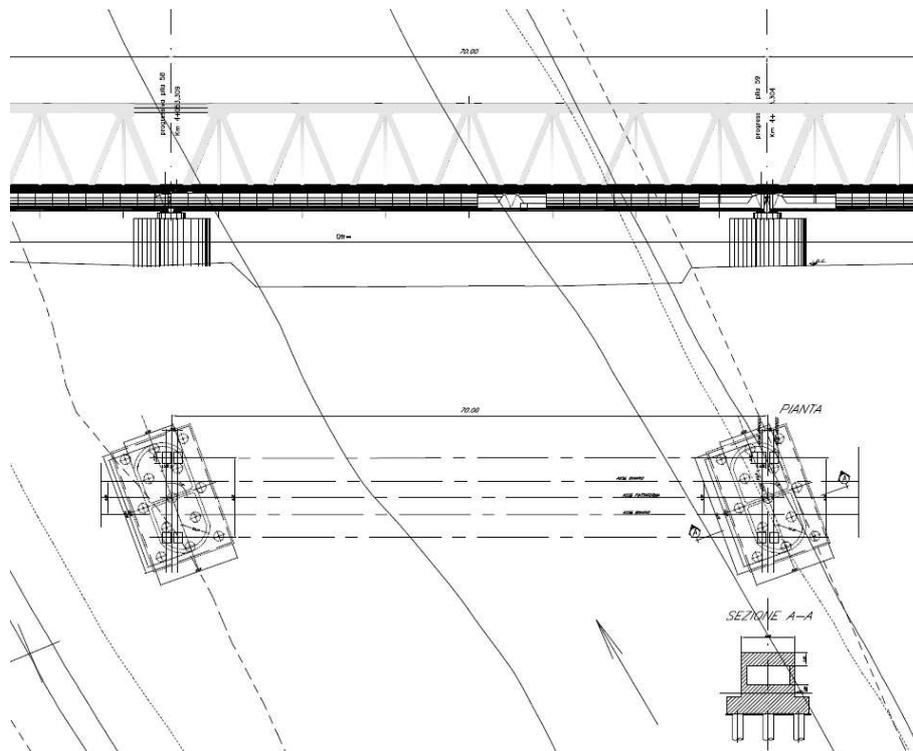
Campate da 70 m su fiume Biferno: pianta fondazioni
